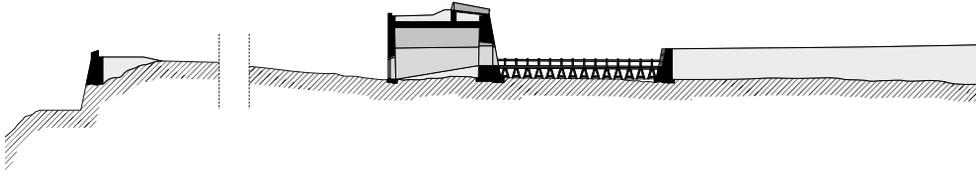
Perfil seccionado 3-3'-4 / Elaboración propia.
